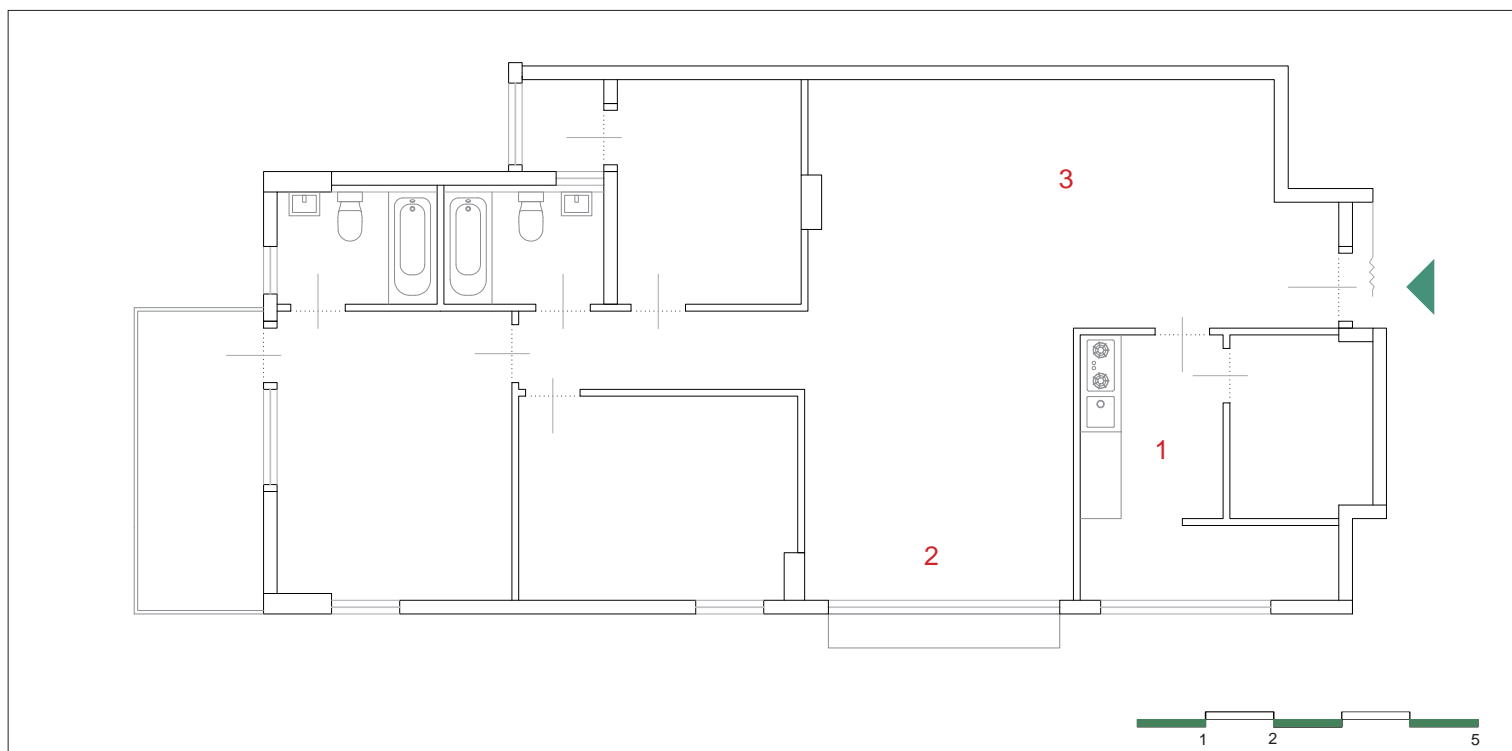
Wohnungsgrundriss - Mei Foo Sun
